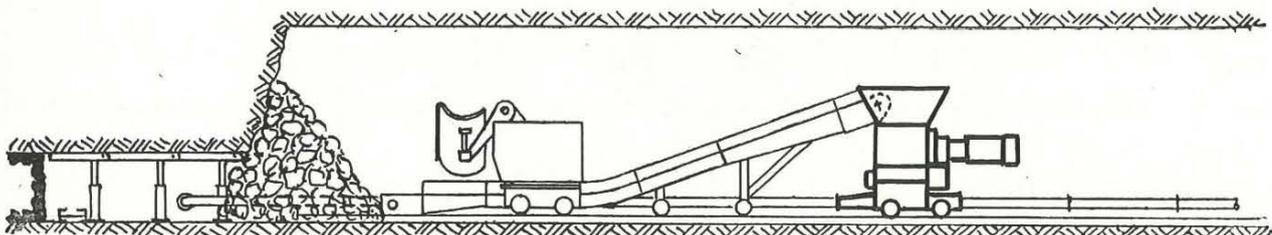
Groupe concasseur-remblayeur, en plateure. Voie creusée en arrière de la taille.
